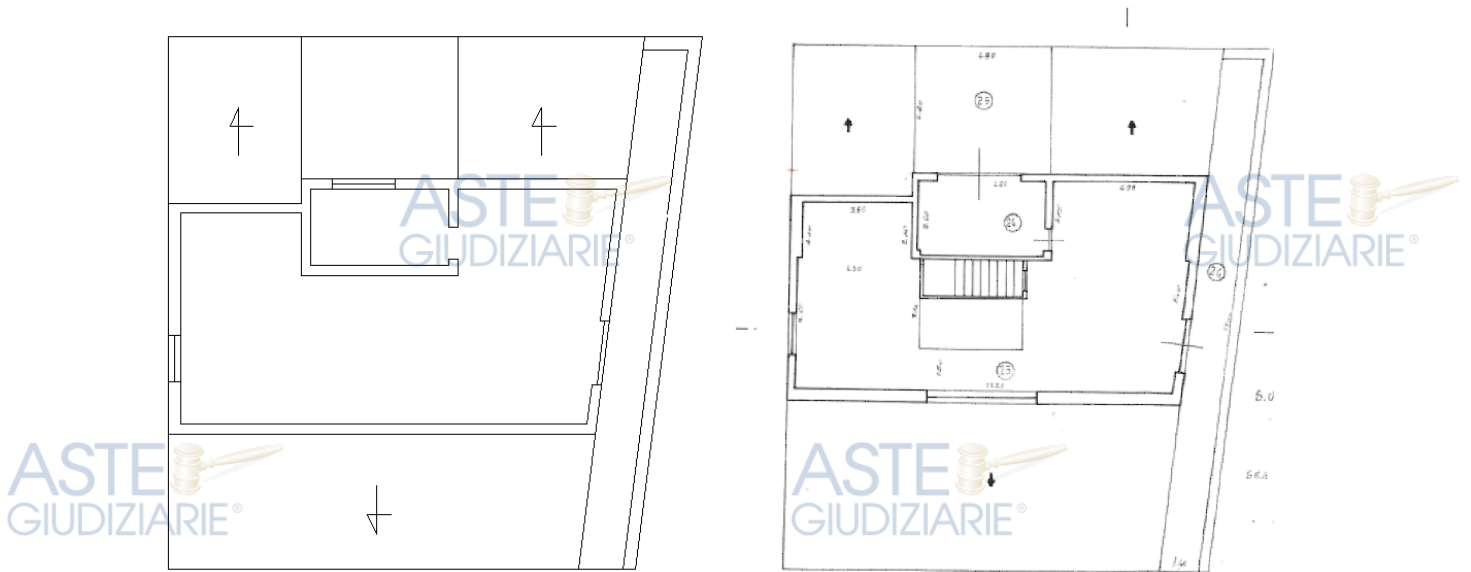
Confronto pianta piano secondo sub. 5 Comune di Teggiano
